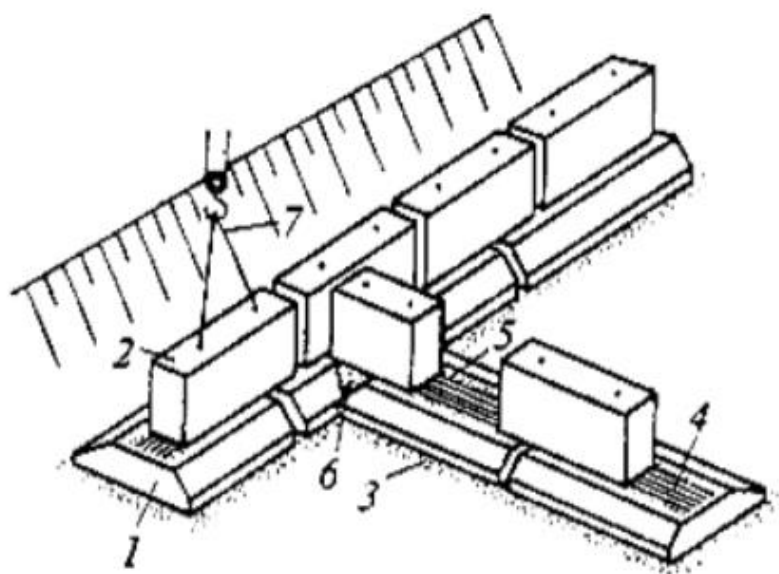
Монтаж сборных ленточных фундаментов:
